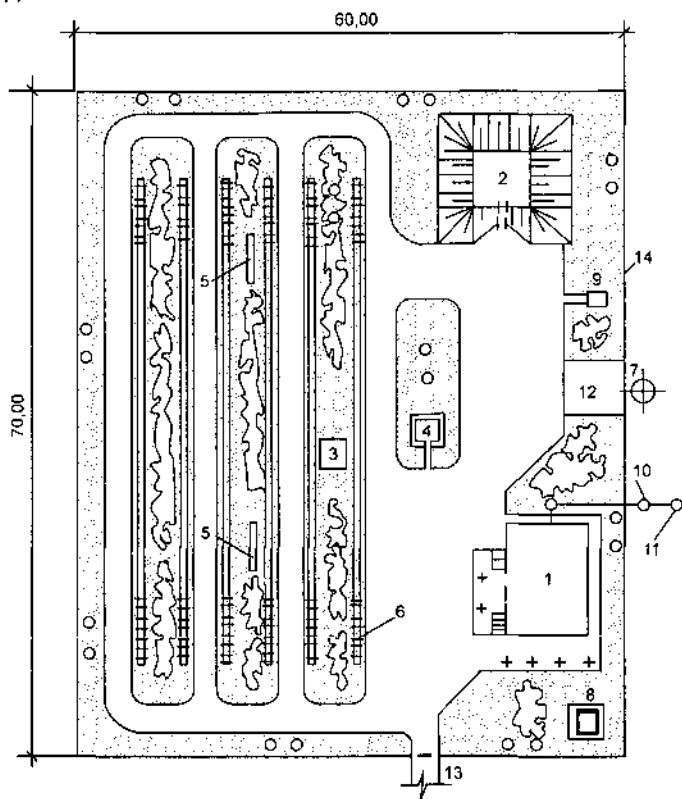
Схема генерального плана пчеловодческой фермы на 150 пчелиных семей (ТП 808-05-18.86):
